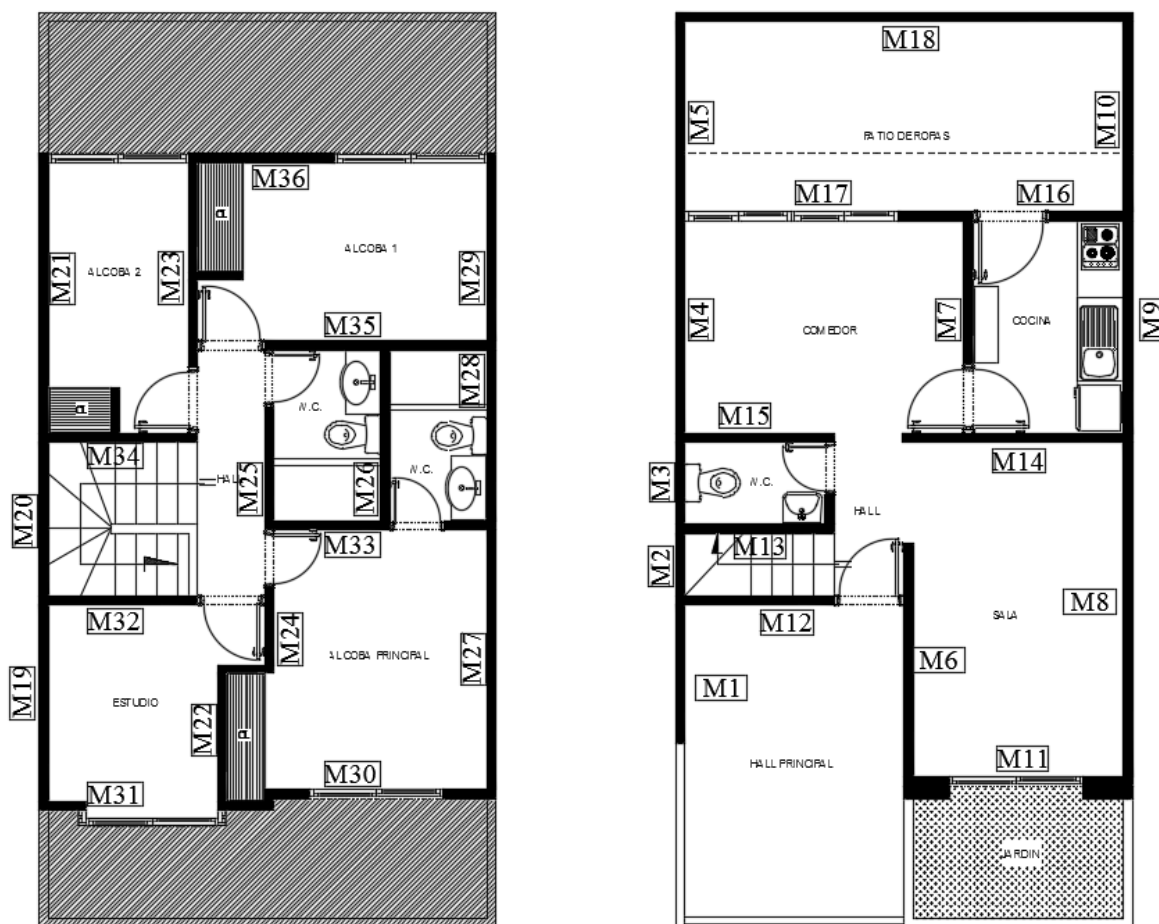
Planta de Segundo y primer piso, respectivamente con enumeración de muros. Fuente propia 2017.
